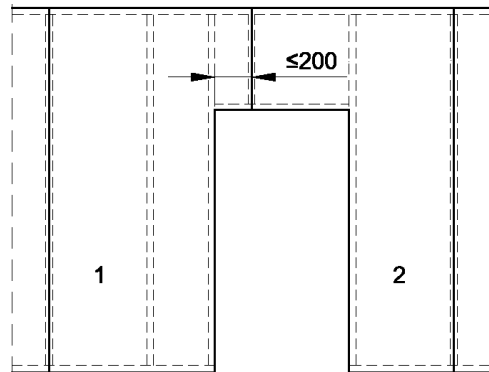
Hueco de puerta con recorte de placa con voladizo sobre el hueco.
